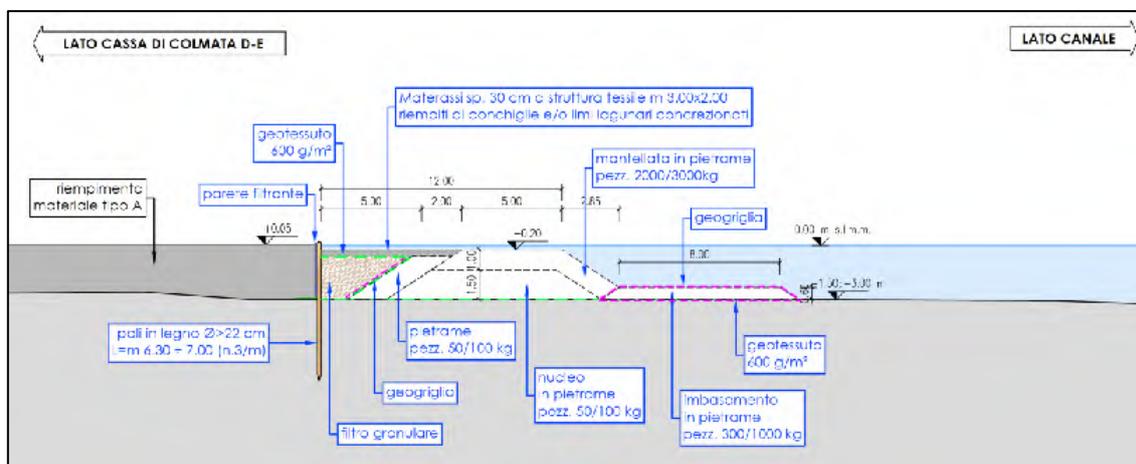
sezione tipo fronte Cassa di Colmata D-E
